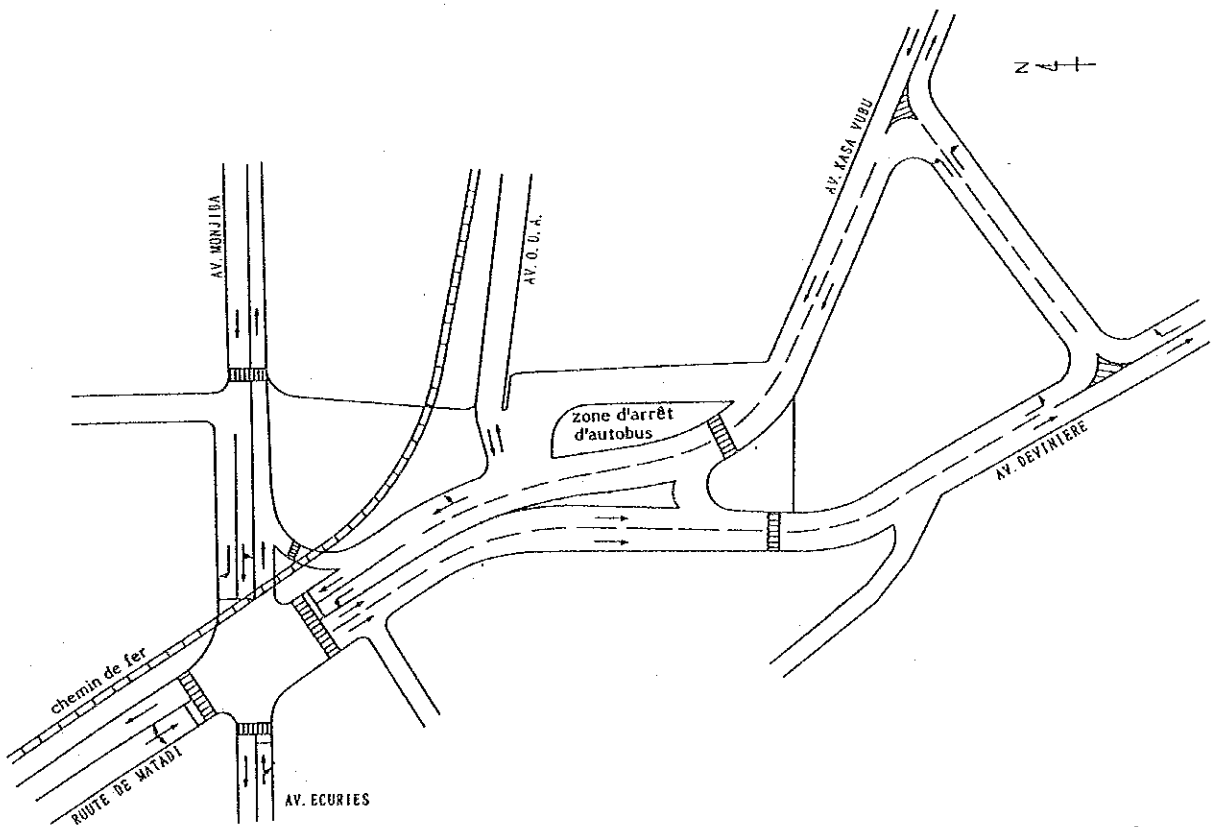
Plan d'aménagement du carrefour de KINTAMBO 1995 (Cas-2)
